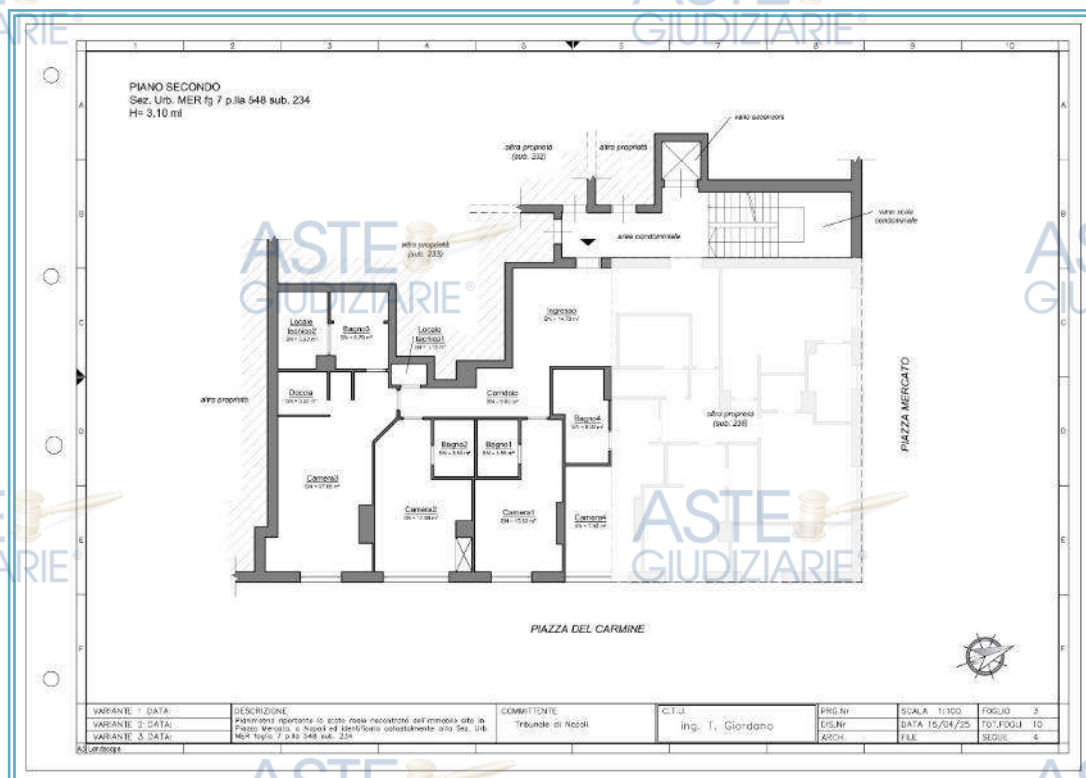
Stato di rilievo – Piano Secondo (LOTTO 10)
